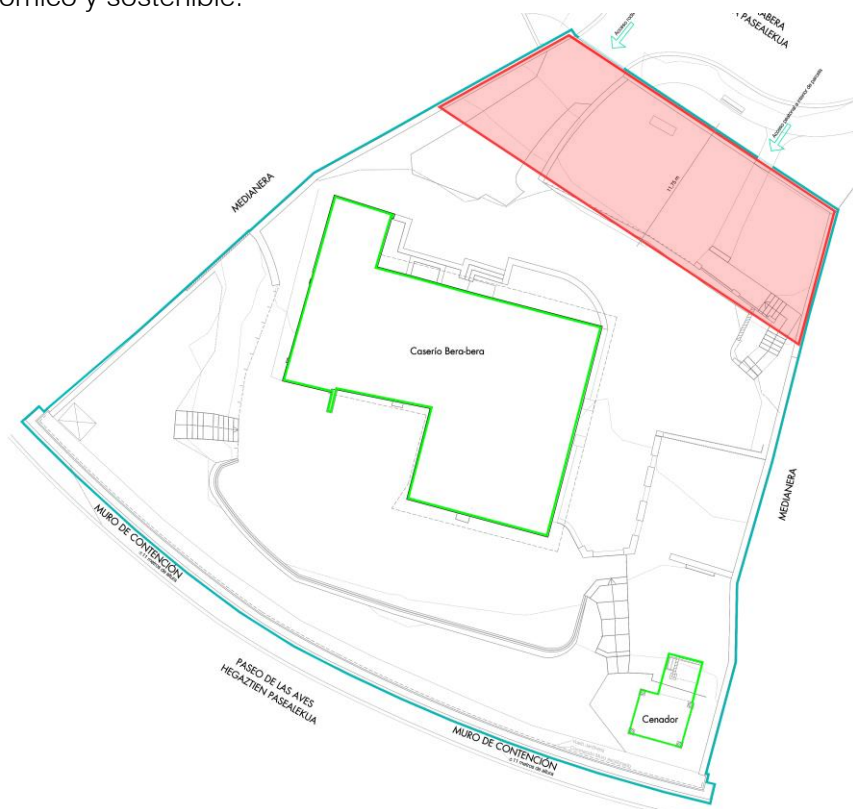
Sección de la parcela; en rojo la edificación bajo rasante contemplada en la Alternativa 0. Fuente: Estudio de Detalle.
